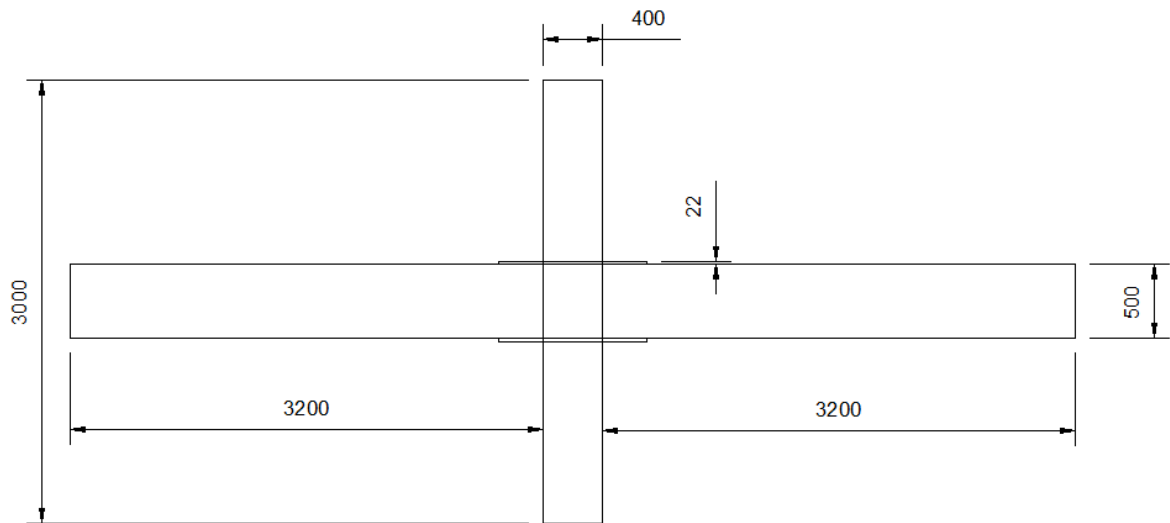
Vista frontal de la conexión viga I-columna tubular rectangular compuesta con diafragma externo. (Dimensiones en *mm*)
